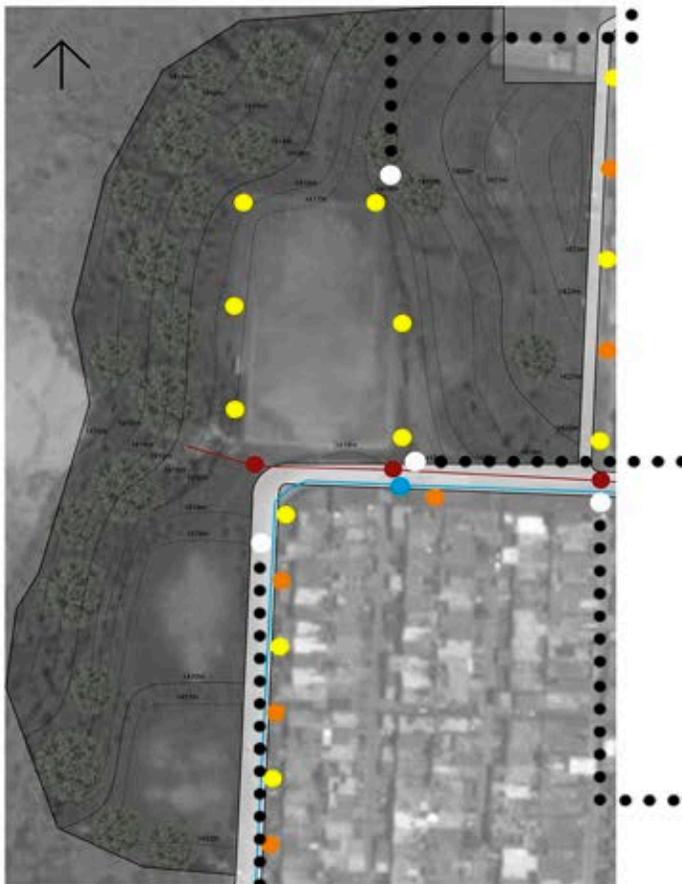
/ POSTES ALUMBRADO CANCHA, TERRENO
